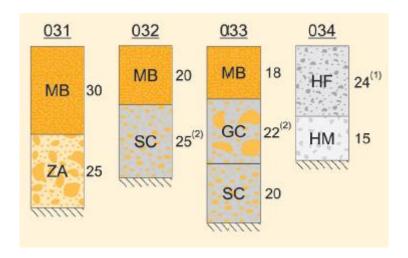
Sezioni potenziali per la pavimentazione stradale della zona ad analizzare
